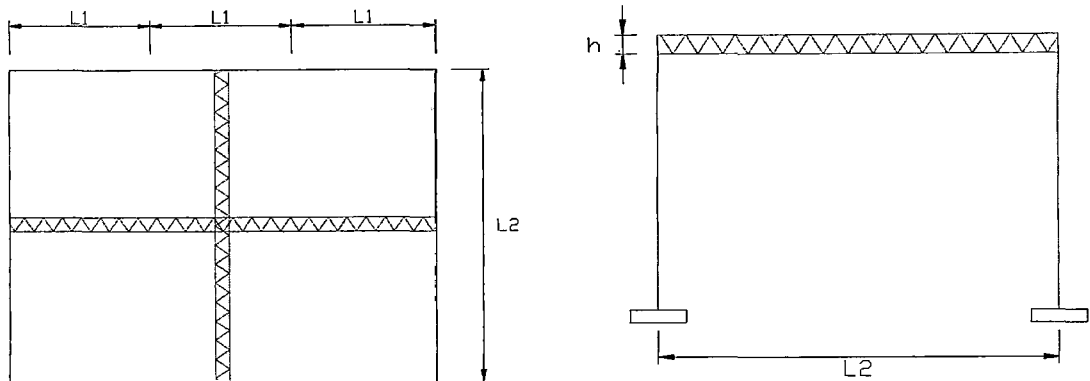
Vista en Planta y Elevación de un Techo Plano
